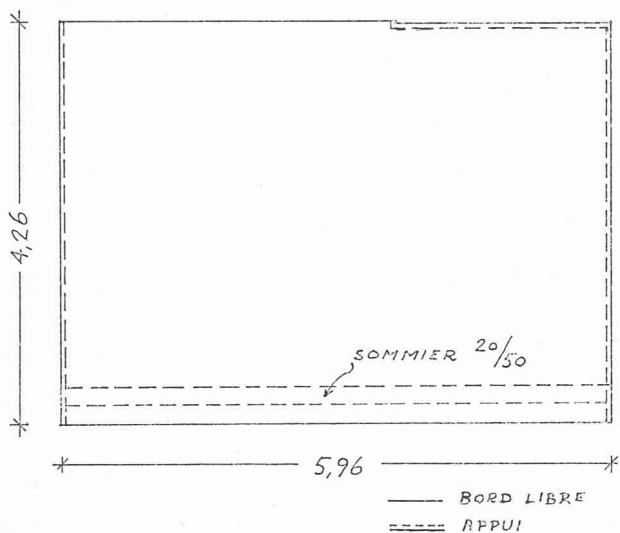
Dimensions et conditions d'appui d'une dalle préfabriquée.
